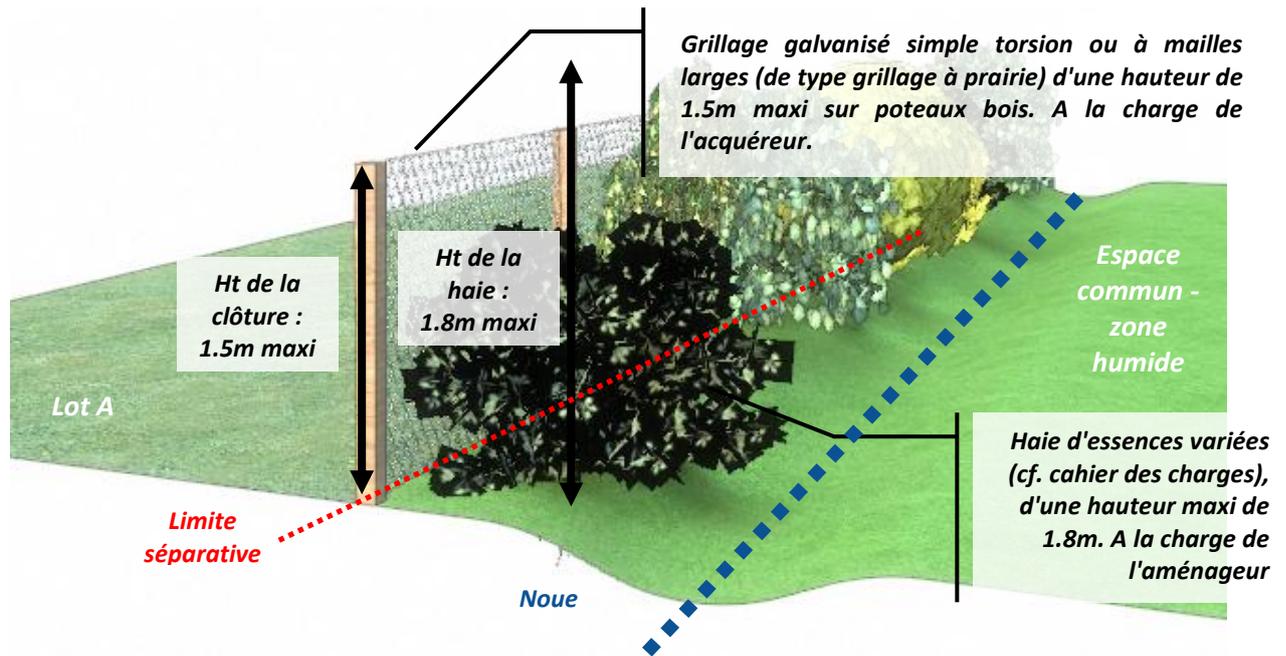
Maquette 3D du rendu concernant la haie et la clôture en bordures de zone humide et d'un espace commun dans le d'un grillage de type "prairie"
